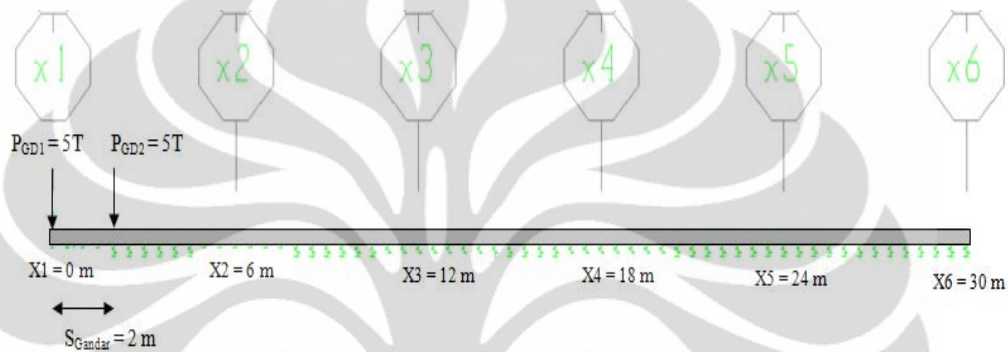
Pembebanan balok rel sepanjang bantalan
